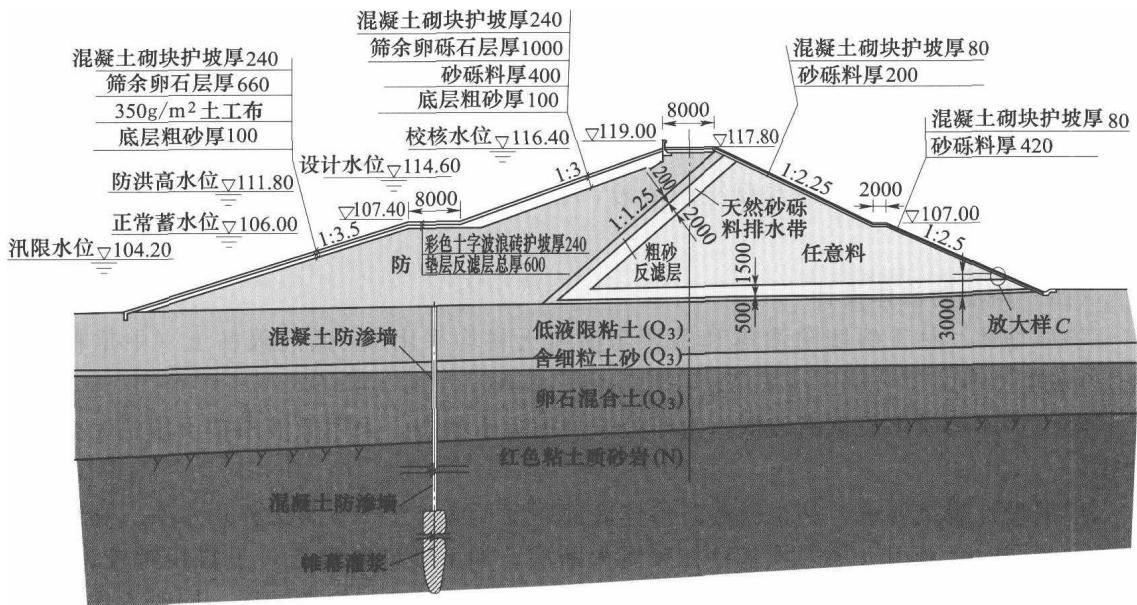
二级阶地（桩号 4+200.00）大坝横断面图（尺寸单位：mm）
